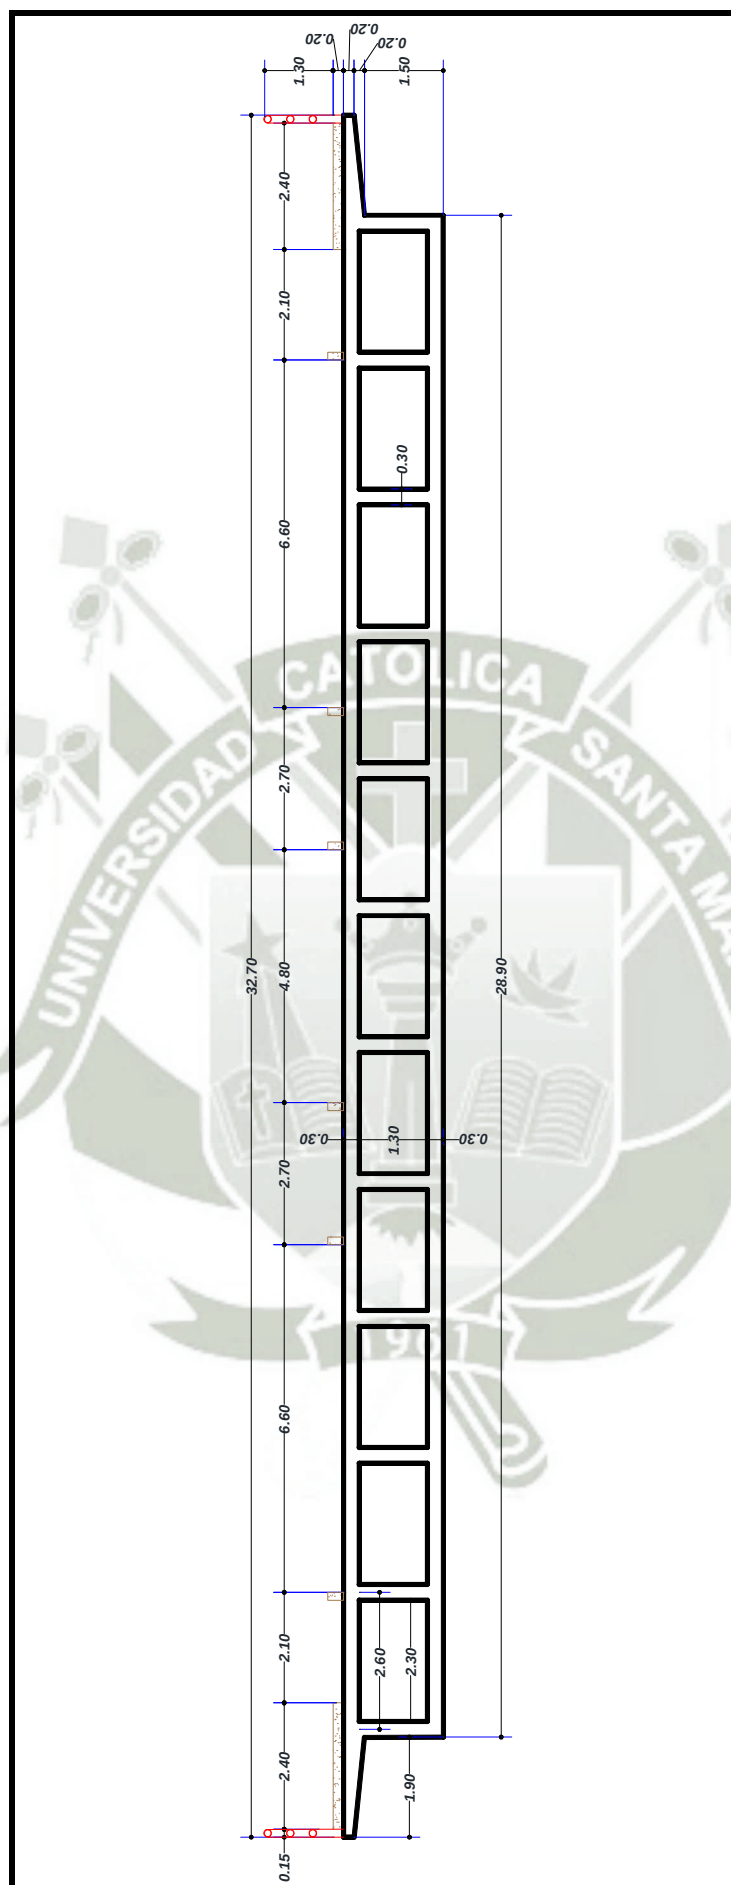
Sección Transversal del Puente Tipo Cajón Multicelular – Puente Añashuayco
